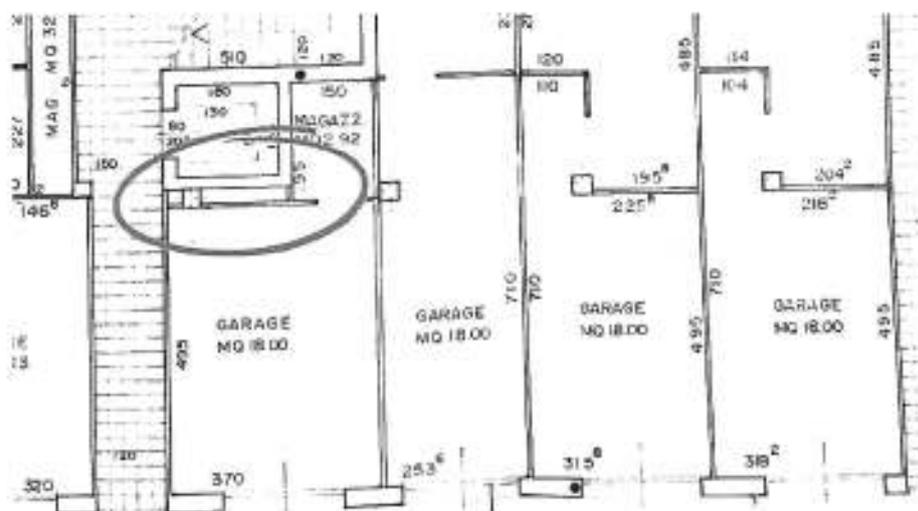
elaborato grafico architettonico pianta piano terra garage – particolare rifodera verso vano ascensore
